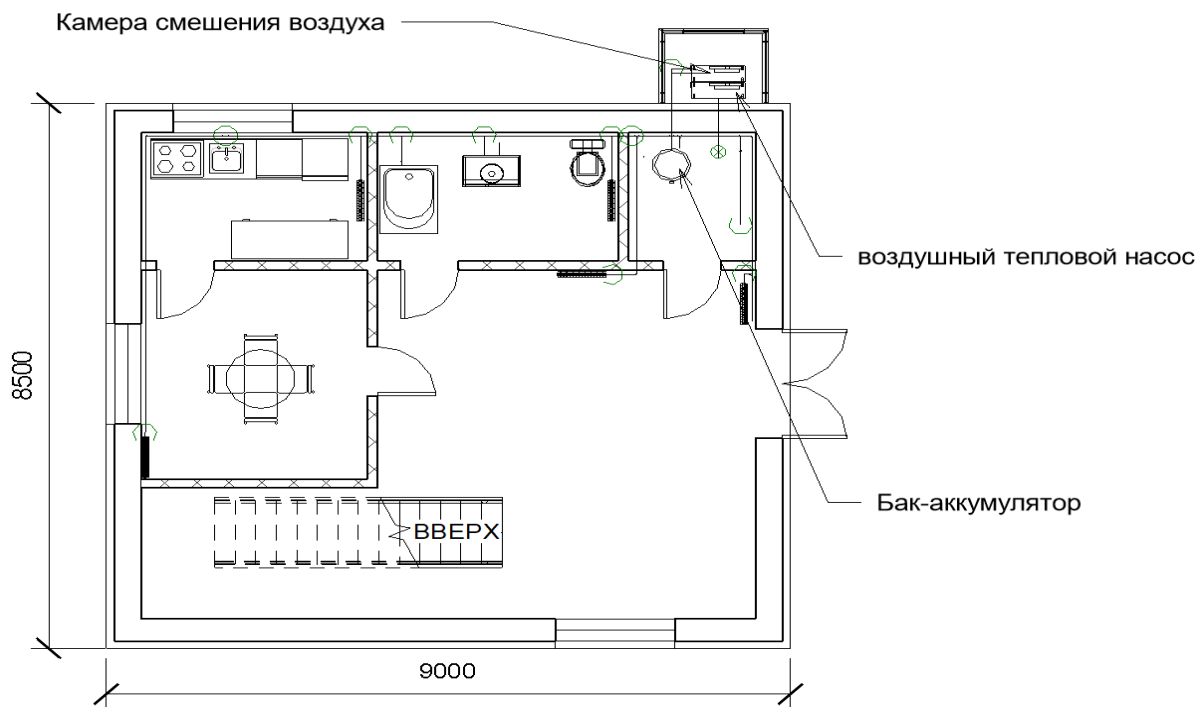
План расположения ВТН снаружи отапливаемого здания
